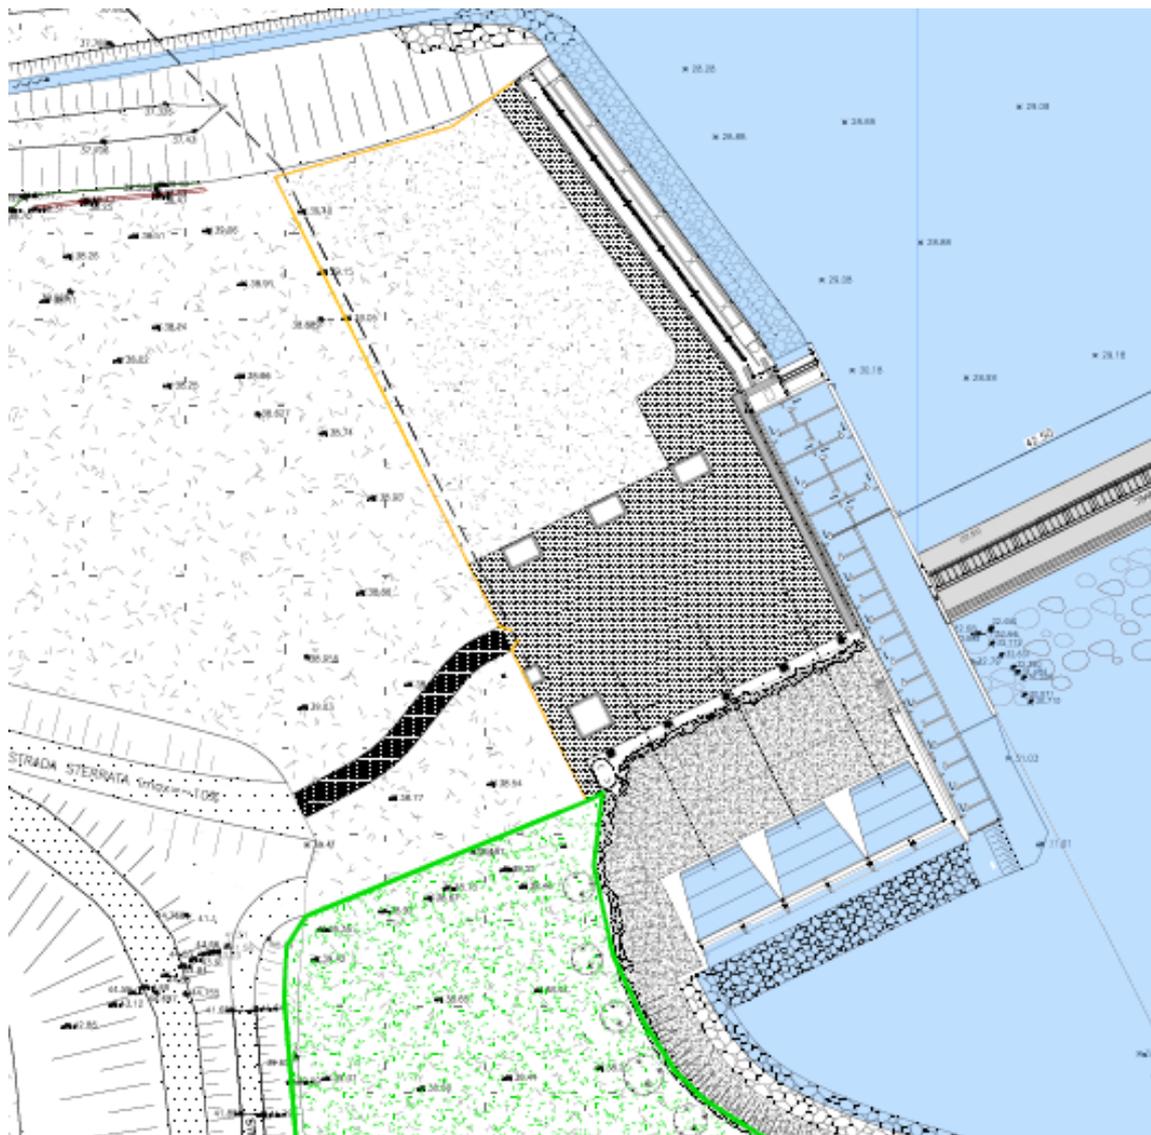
Planimetria di progetto con la centrale interrata e l'area verde di mitigazione
